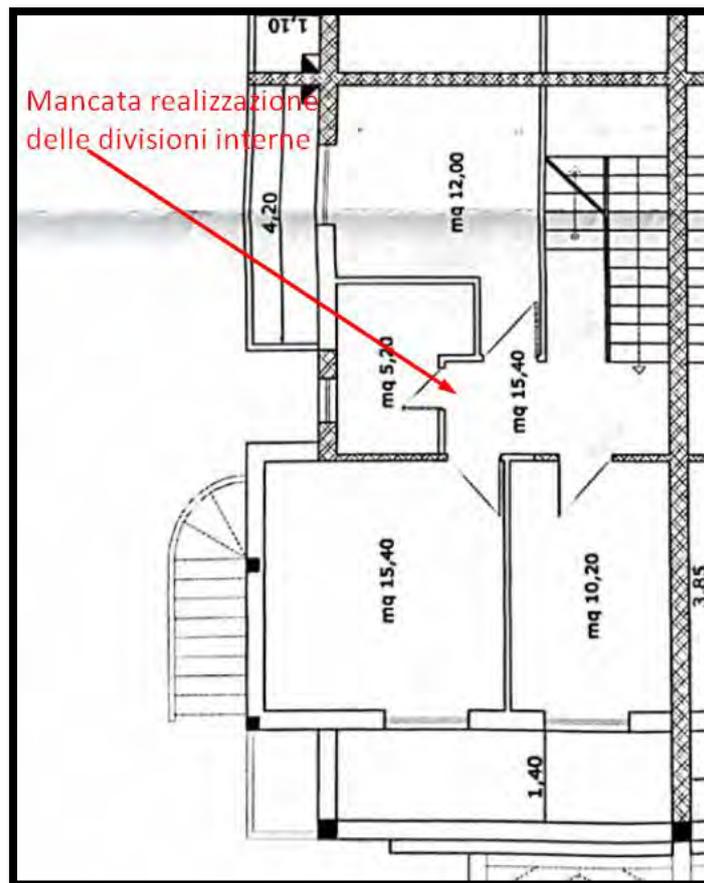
Pianta piano secondo allegata alla CILA prat. n. 294/2011
